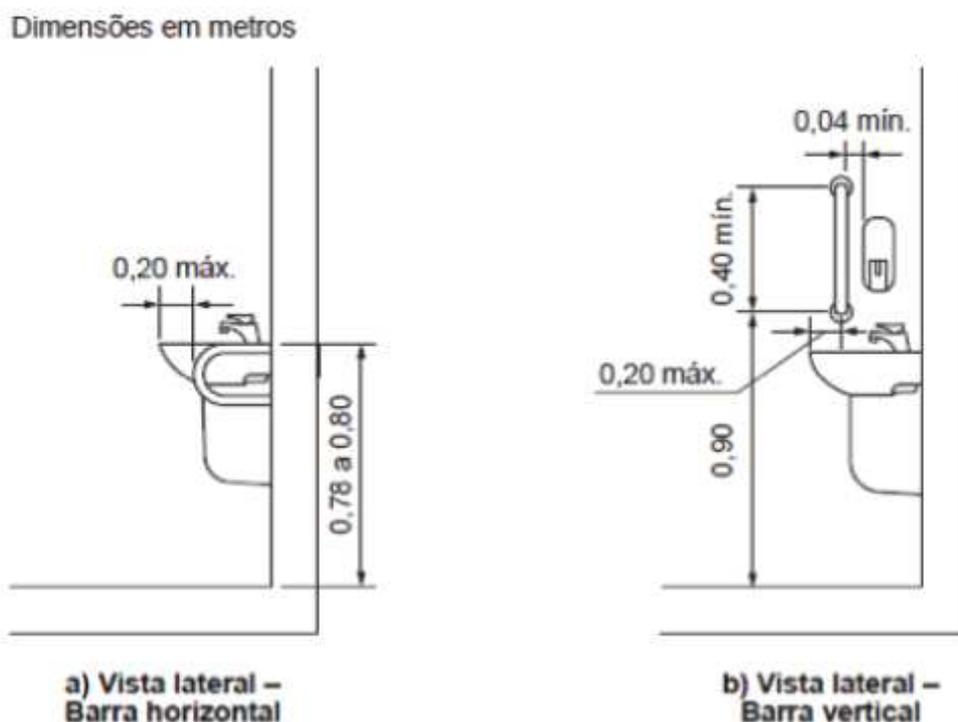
Barra de apoio no lavatório – Vista lateral
